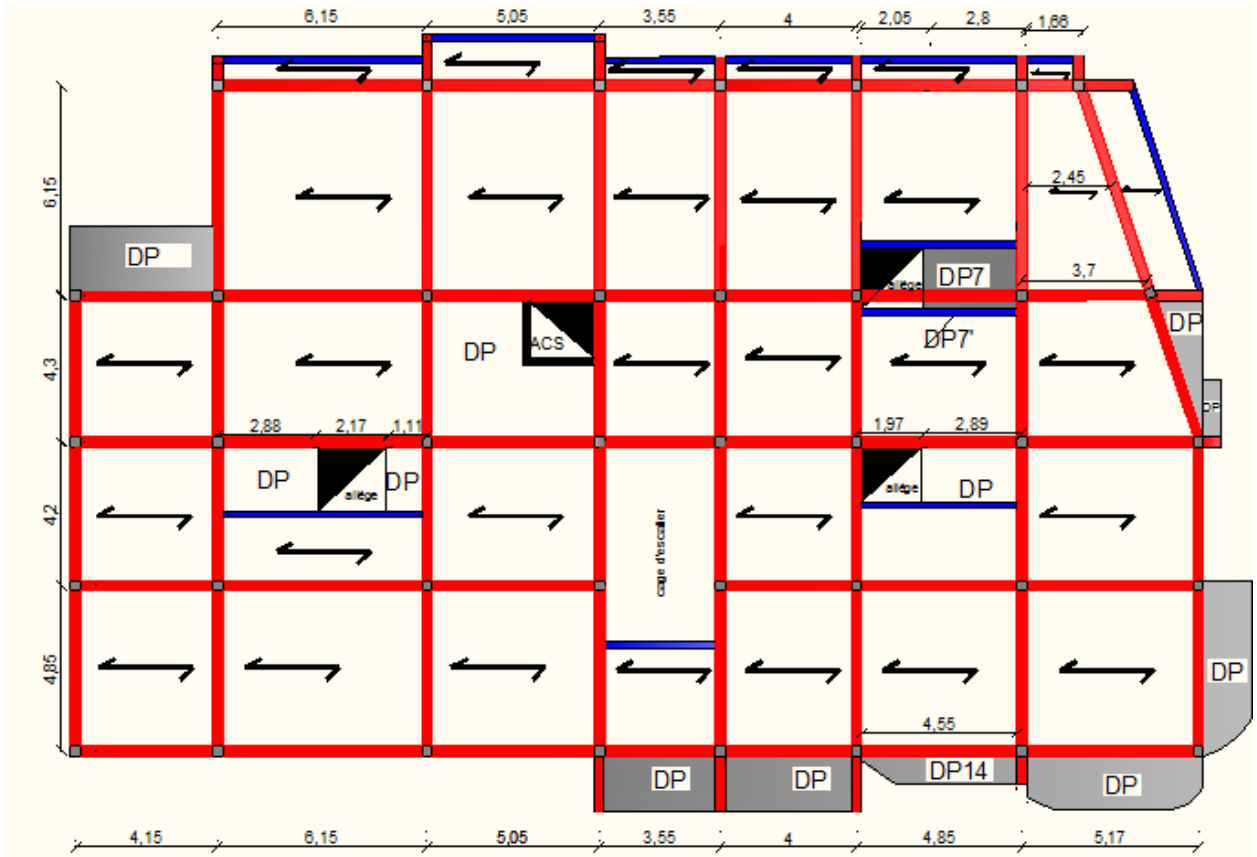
Disposition des poutrelles (de 2 au 7^{me} étage).
